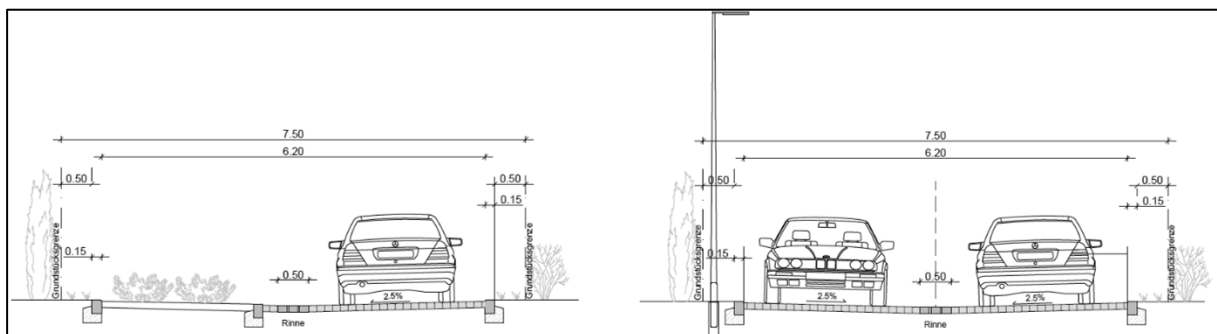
Regelquerschnitt der Planstraße B gemäß Erschließungsvorplanung
